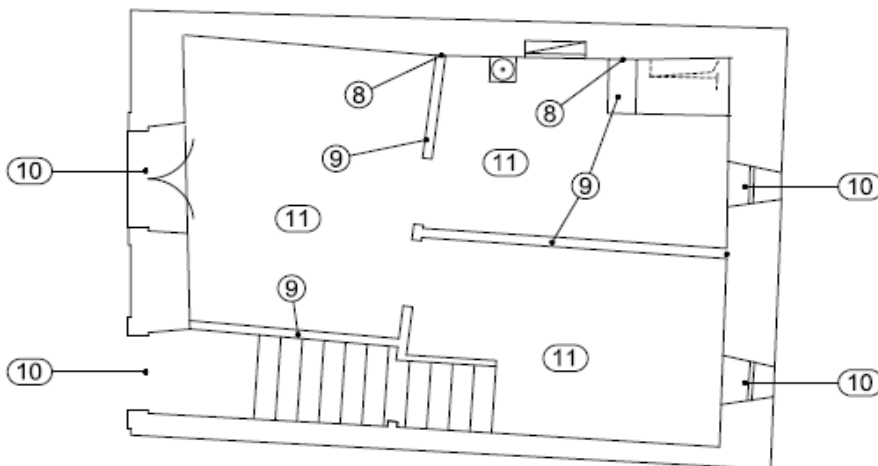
esquema da demolição do piso 0 em planta (Nunes, projeto de demolição, 2016)
